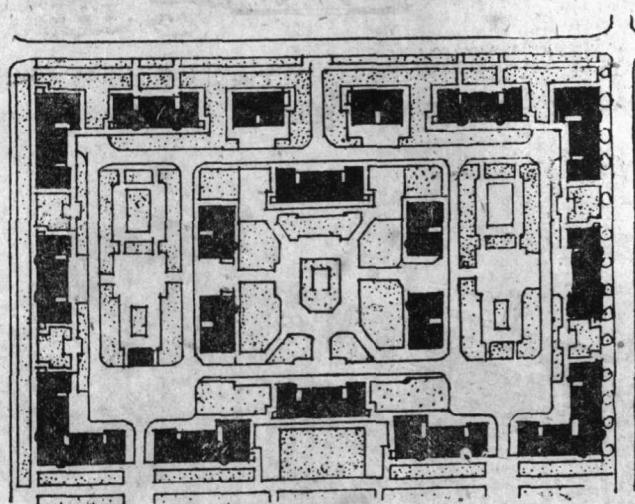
B 苏联扎波罗什城少层建筑街坊(2层)平面图
